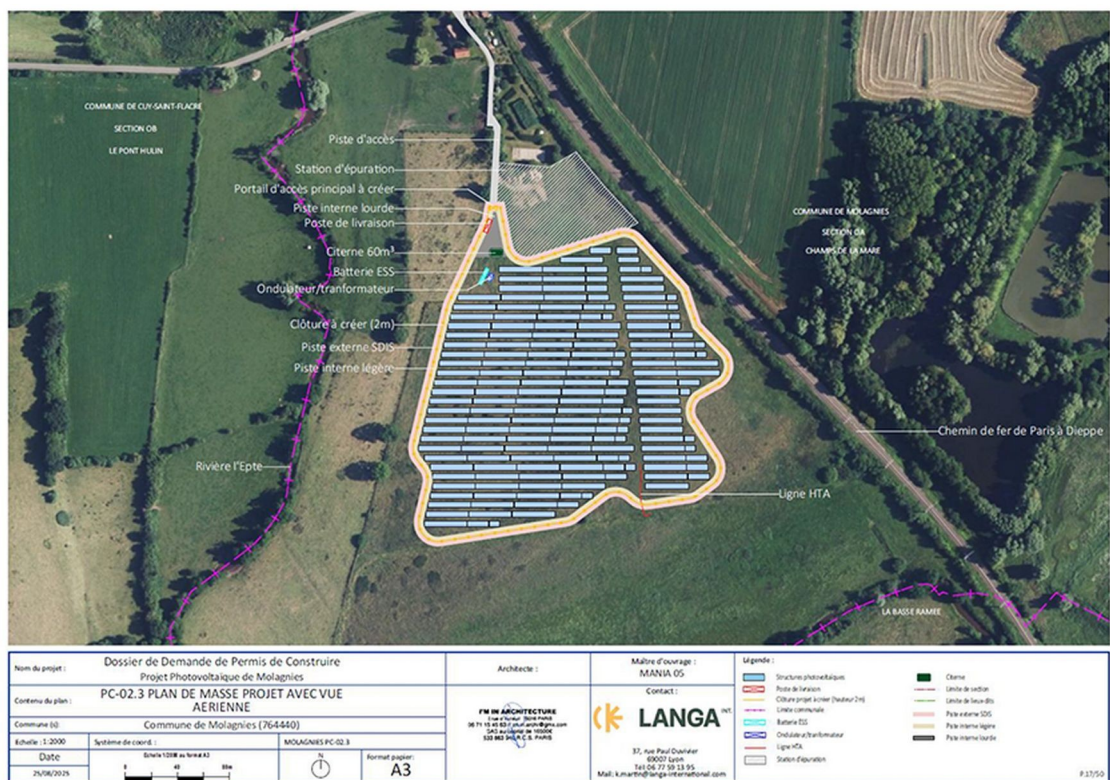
plan de l'implantation (ill. 1, p.8 EI)
